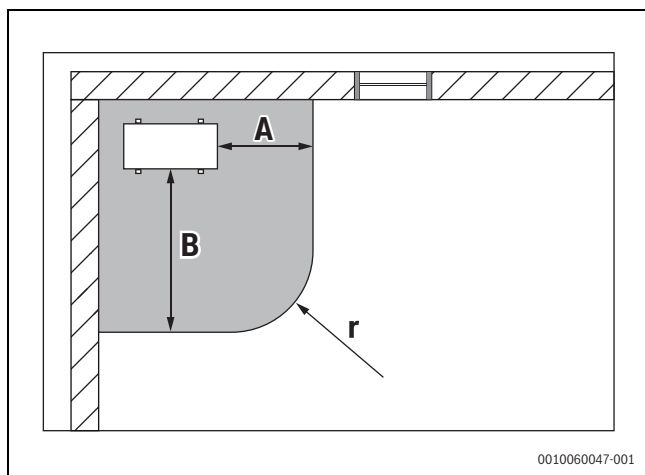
Zona di sicurezza posizionamento a terra in un angolo, vista dall'alto
